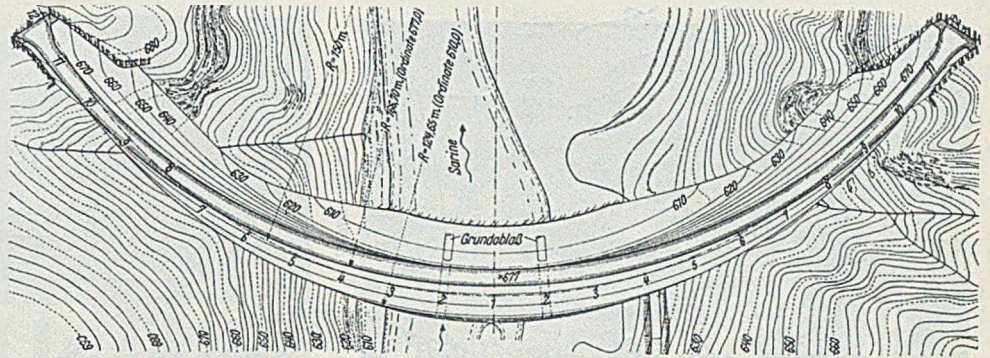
Rossens-Staumauer (Schweiz). Grundriß und Höhenlinienplan.
